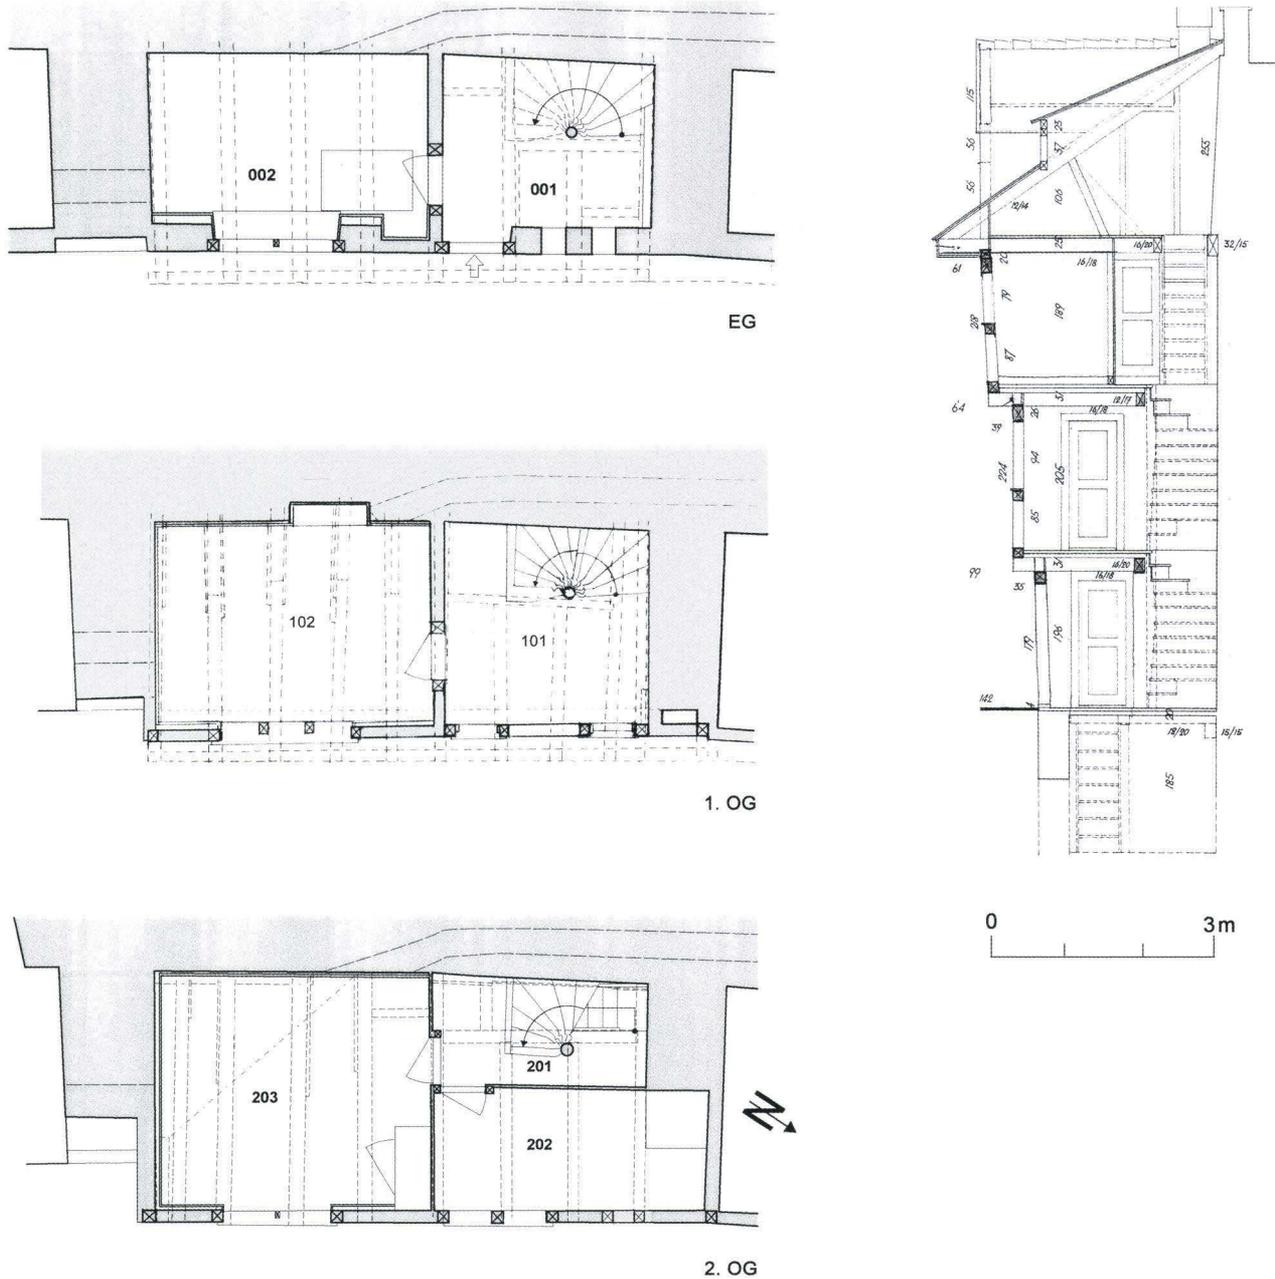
Rheinsprung 8. Geschossgrundrisse mit Raumnummern. Das Haus ist weitgehend zwischen die mächtigen Strebe­pfeiler der Stützmauer des Martinskirchplatzes gestellt. – Plan: TAD-Plan. Umzeichnungen: Andy Stulz, Clemens Staub, Matthias Merki.
